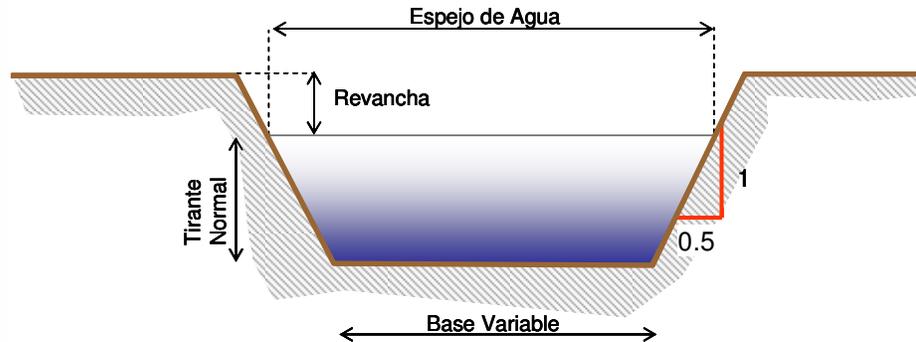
Corte tipo de canal definitivo excavado en tierra
